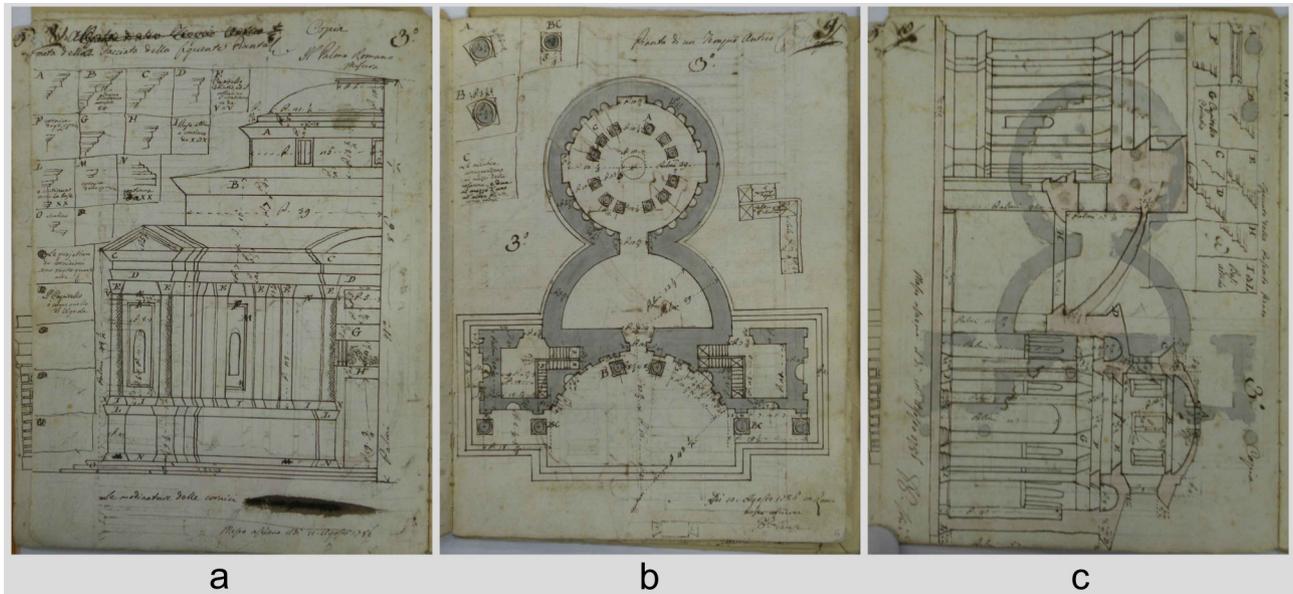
Tempio antico: a) semi-prospetto con dettagli; b) pianta; c) sezione con dettagli. Cipriani 1786-1791, cc. 5v, 6r, 6v.
